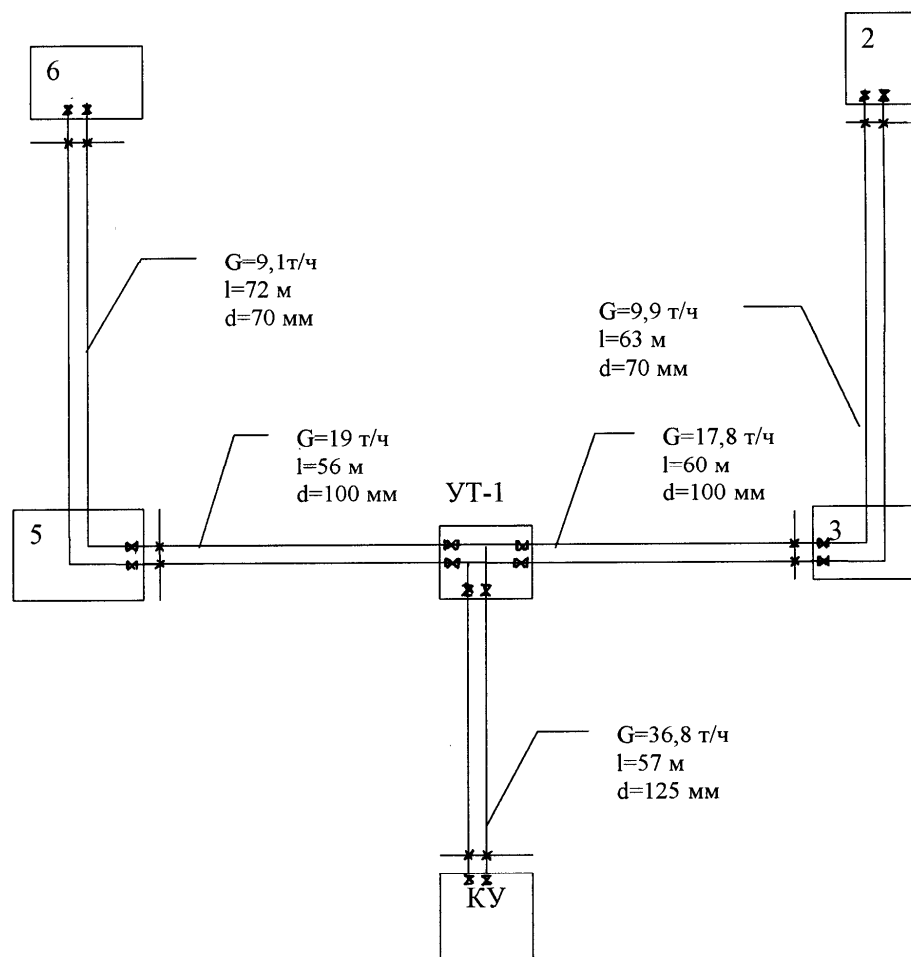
Расчетная схема тепловой сети после реконструкции
